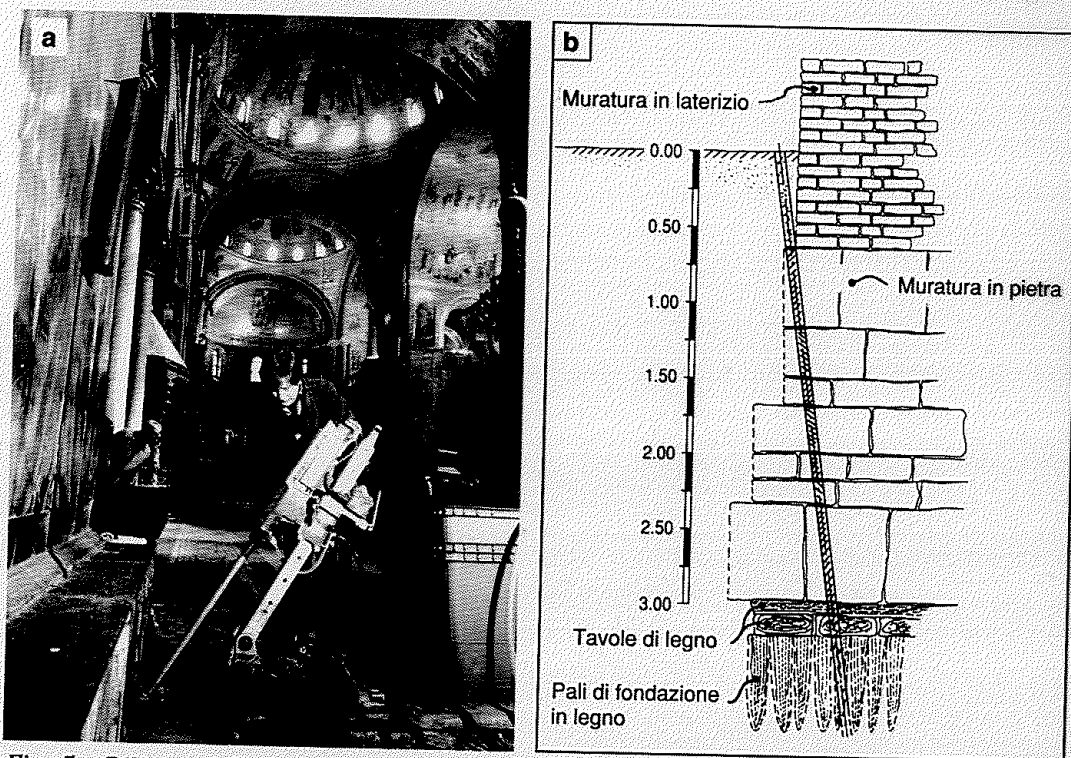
Rilievo delle strutture di fondazione dei pilastri della Basilica di S. Marco in Venezia mediante carotaggi meccanici a) Attrezzatura di perforazione b) Schema strutturale delle strutture di fondazione.
